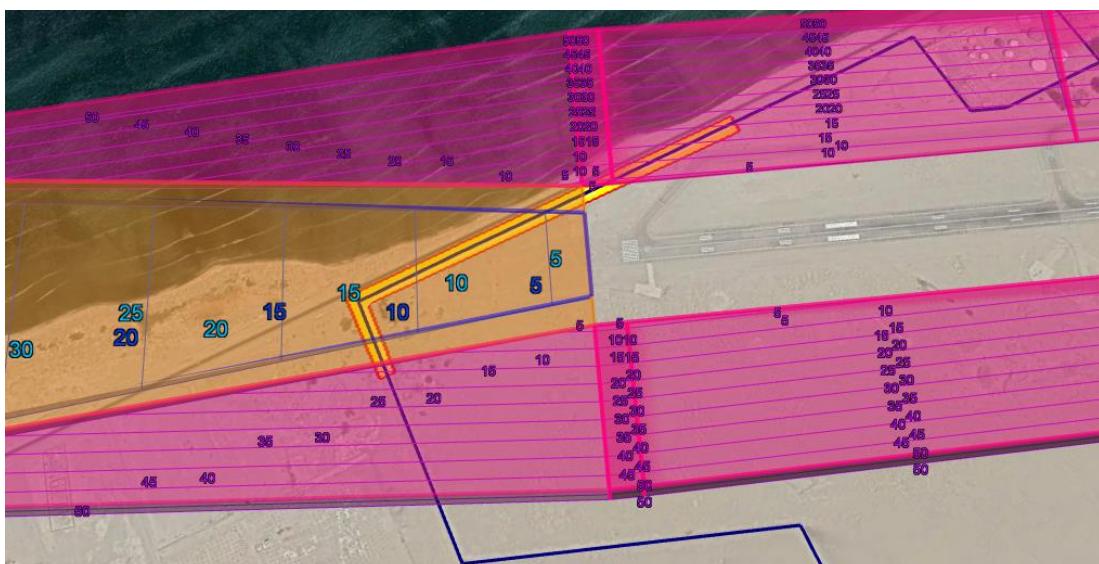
Diseño de Alcantarilla en Vial Perimetral
